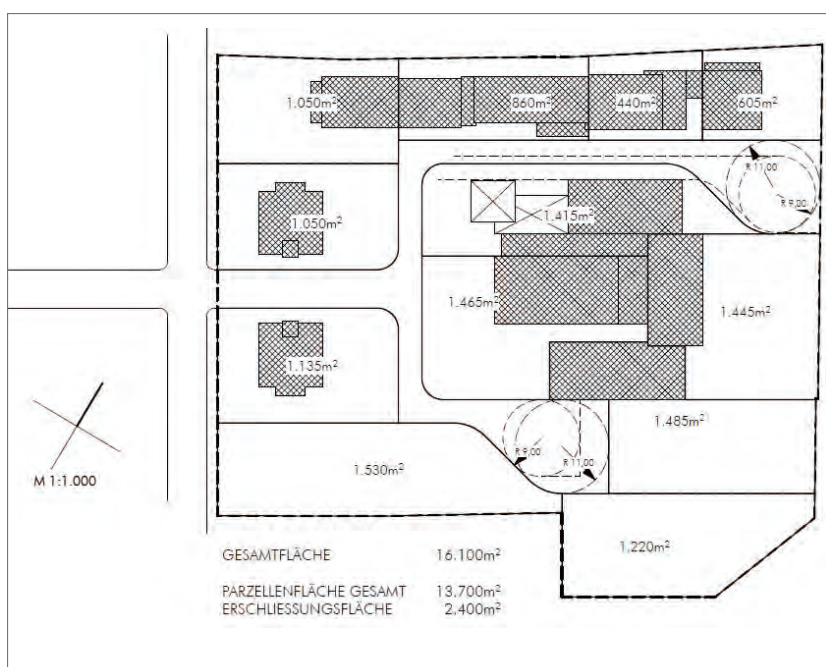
Grundstückspartzellierung und Erschließung Variante 1
